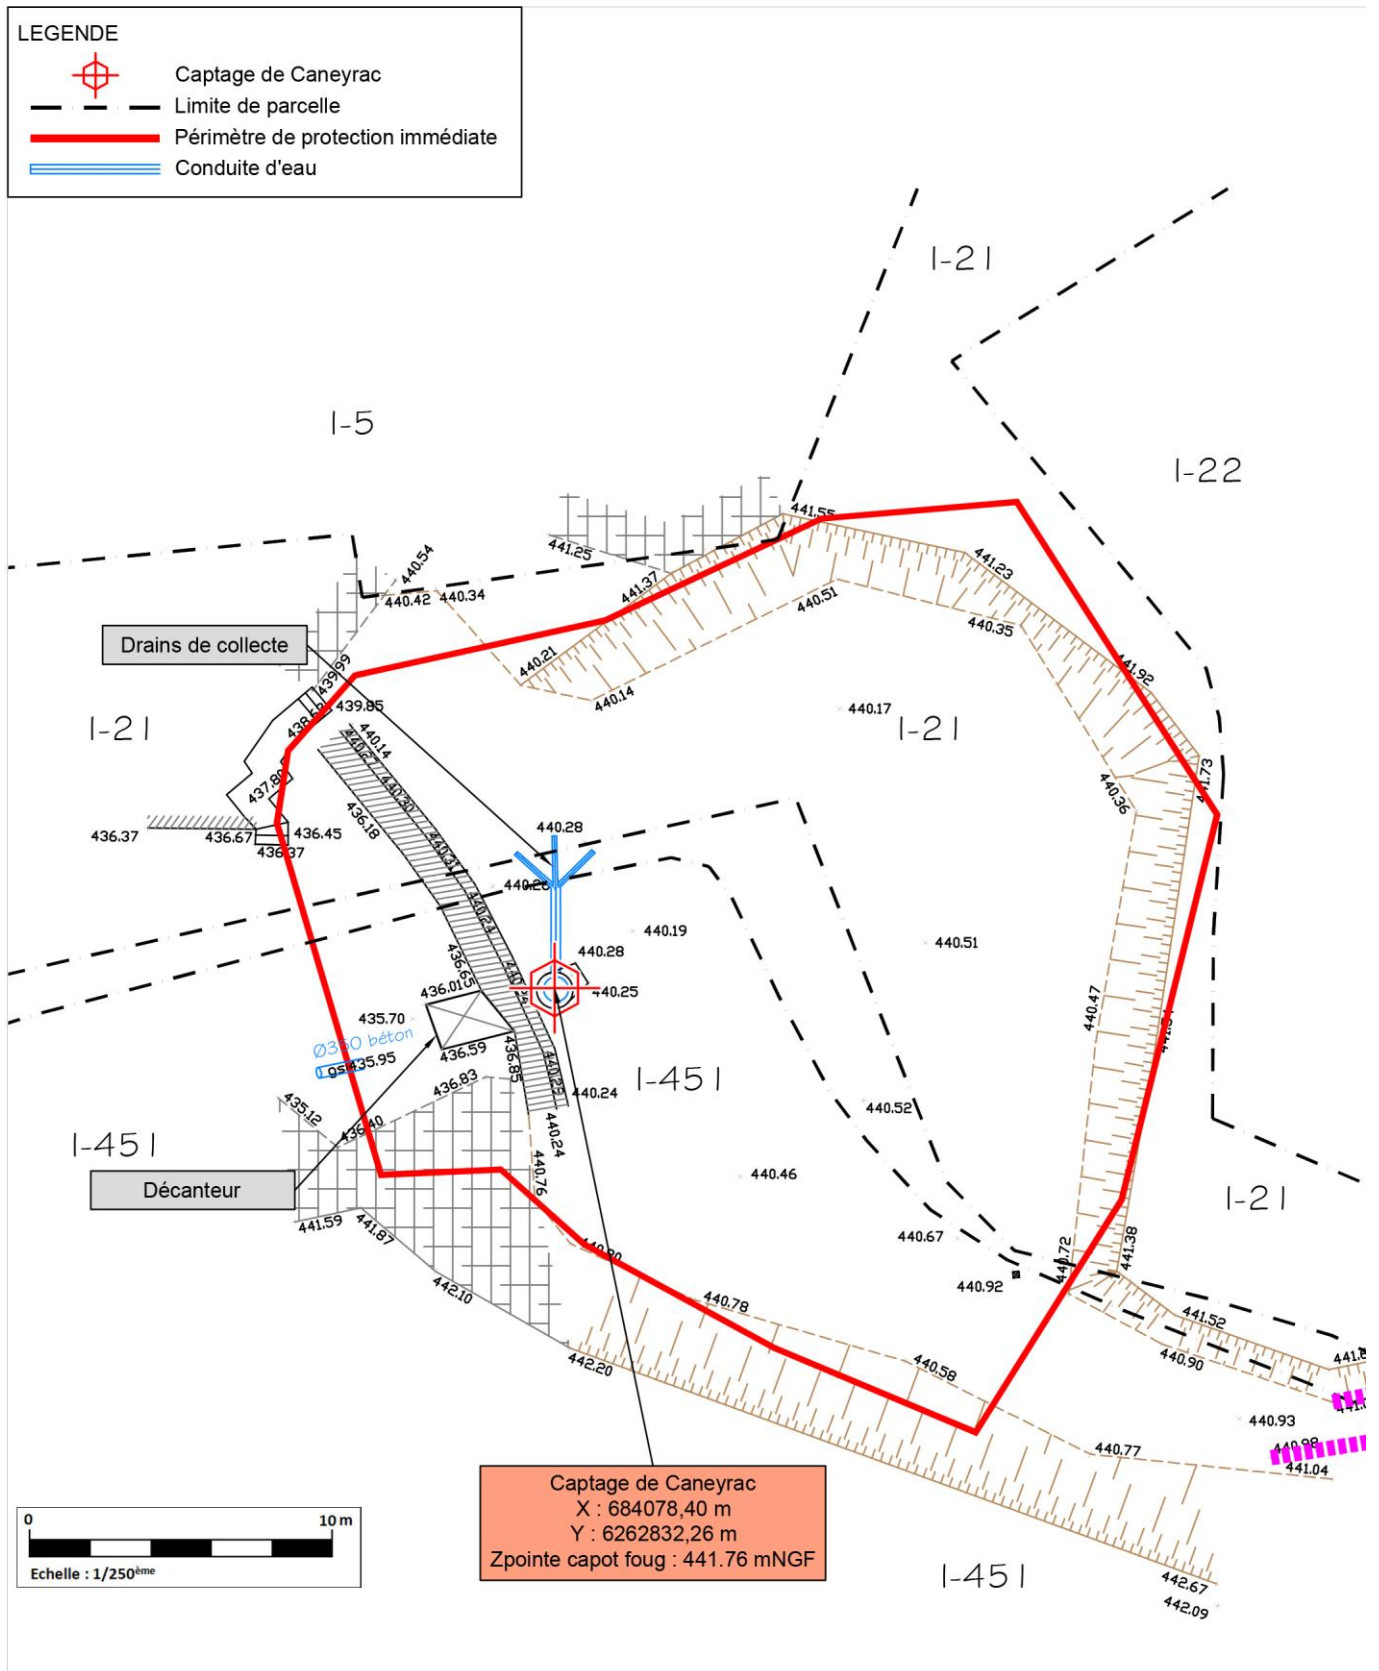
Plan de masse du site de captage de Caneyrac avec report cadastral
